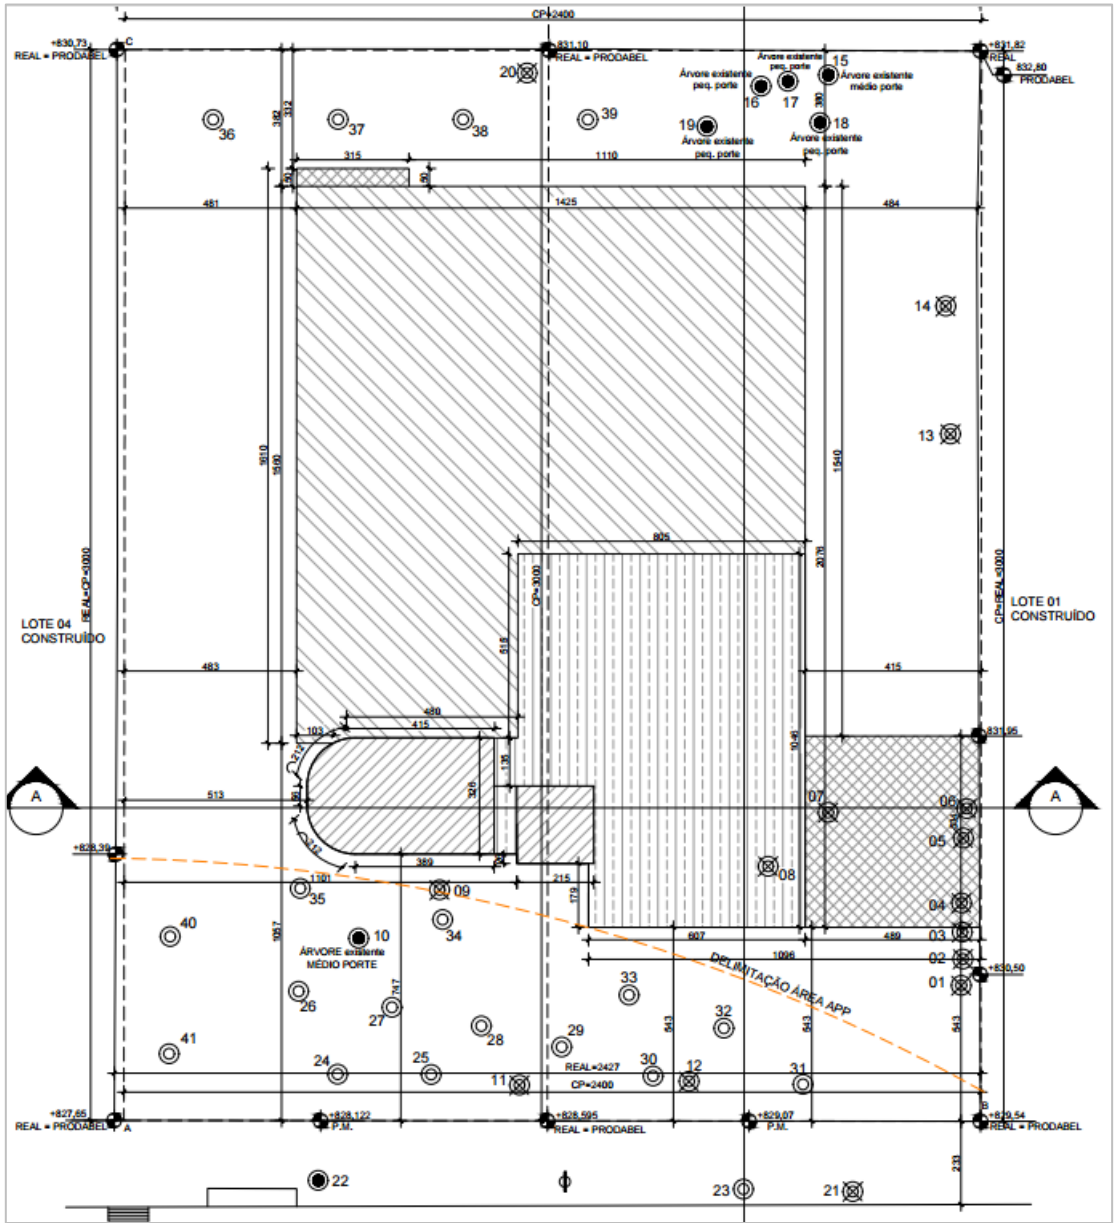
Recorte da planta de situação indicando as árvores a serem suprimidas e plantadas.
